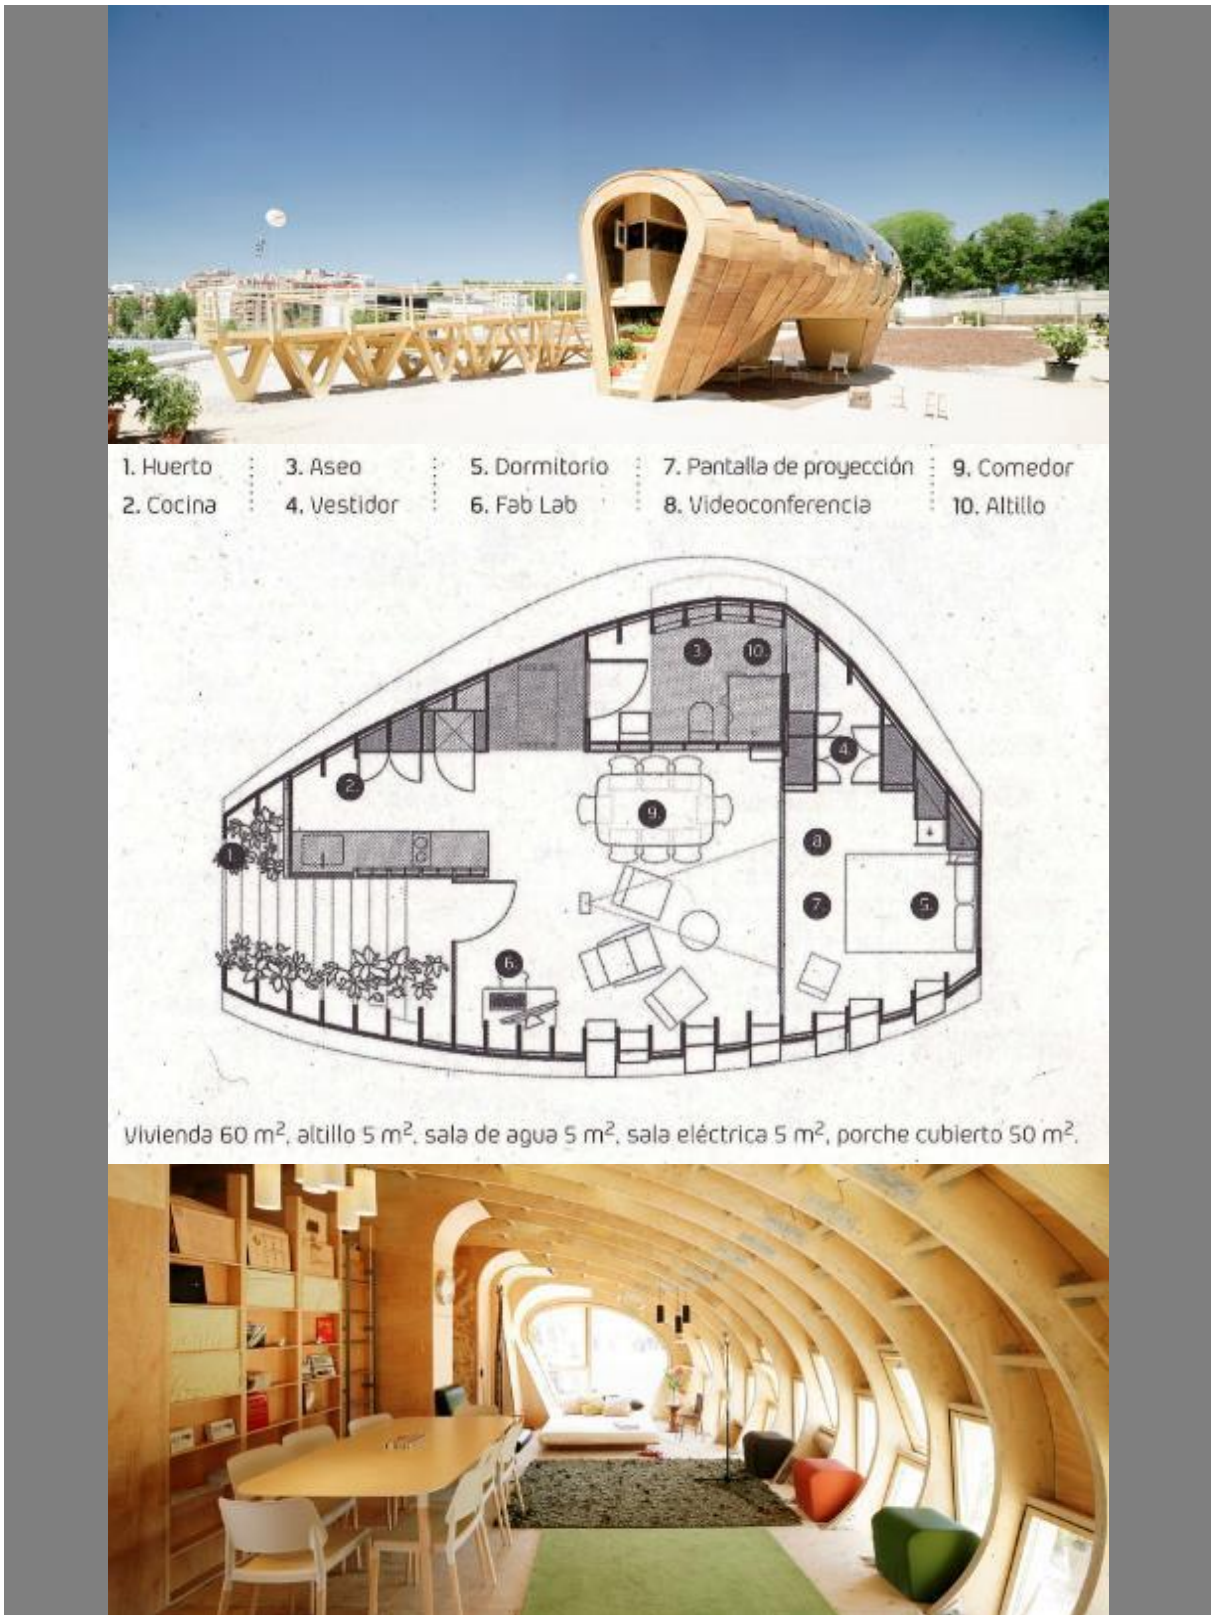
Arriba: rampa de acceso y entrada principal. Al centro: planta arquitectónica. Abajo: una vista hacia la recámara principal. Fuente: Archivo personal.
